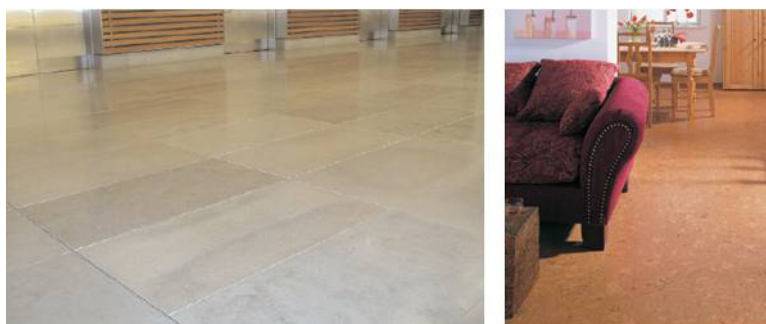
Alcuni esempi di pavimentazione caratterizzata da continuità della texture
